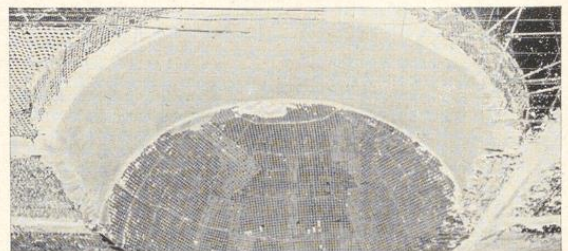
Die Gewölbefläche nach Gipslehren teilweise grundiert
